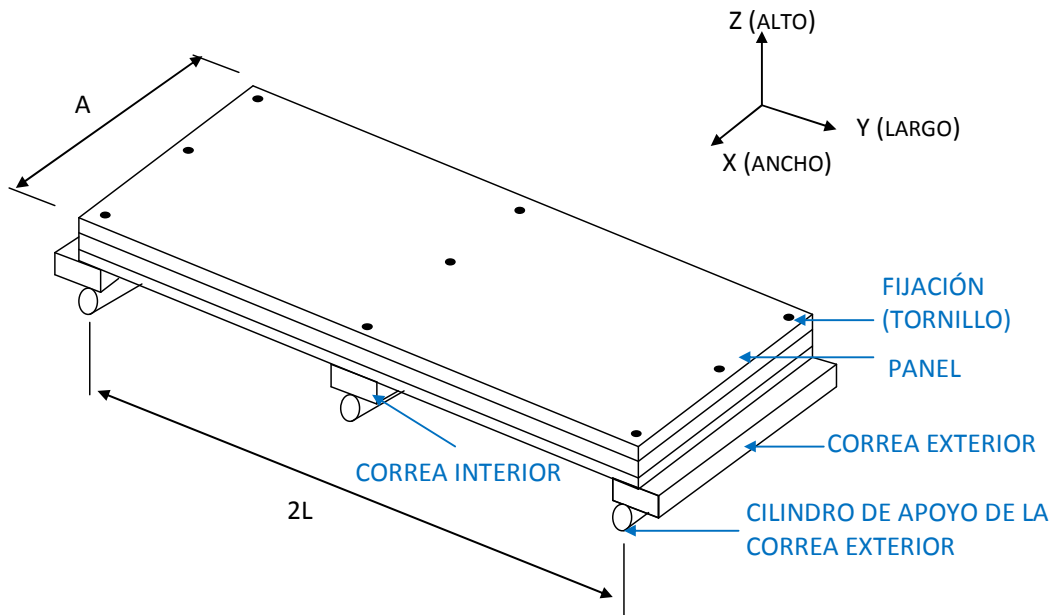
Disposición del panel previamente al montaje del utillaje
